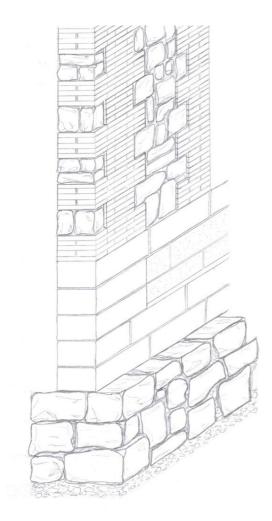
Detalle constructivo de cimentación y arranque de muro de fachada. Fuente: Elaboración propia.
